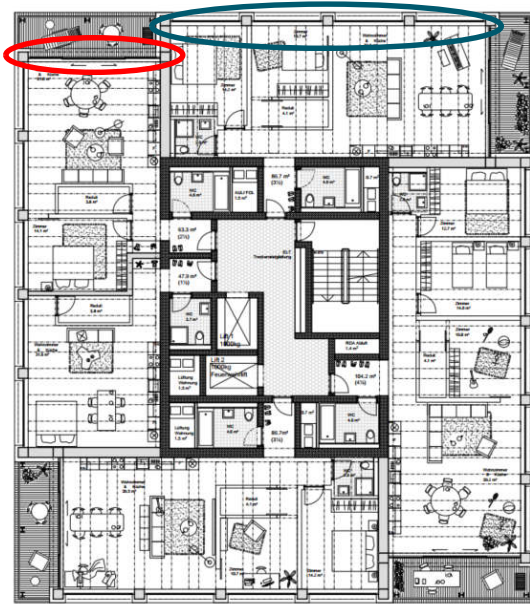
Grundriss 4.-8. Obergeschoss [Quelle: Christ & Gantenbein Architekten, Grundrisse 4.-8.OG; Stand 14.12.2020]
